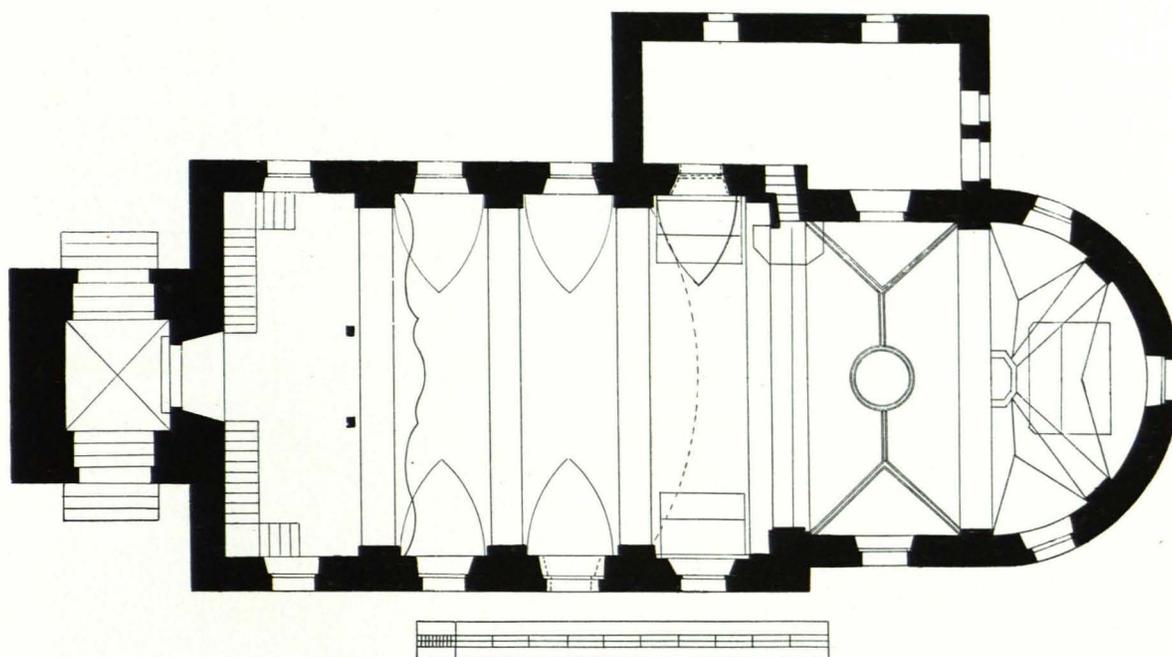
Bergheim, Pfarrkirche, Grundriß 1:200 (S. 31)
